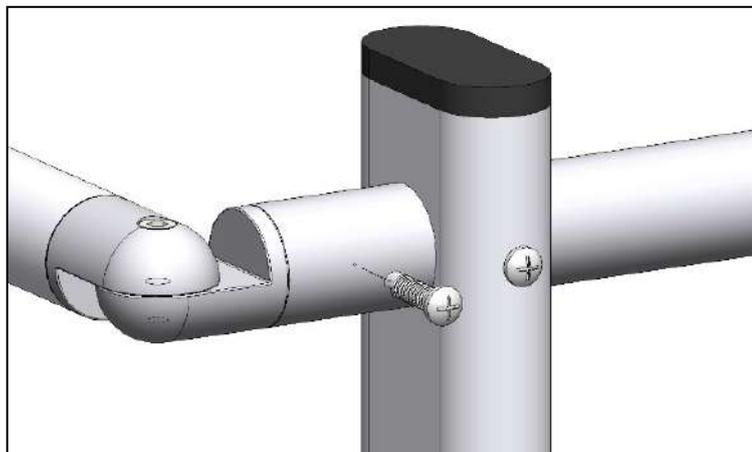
Fijación de la puerta a los barandales del parapeto.
